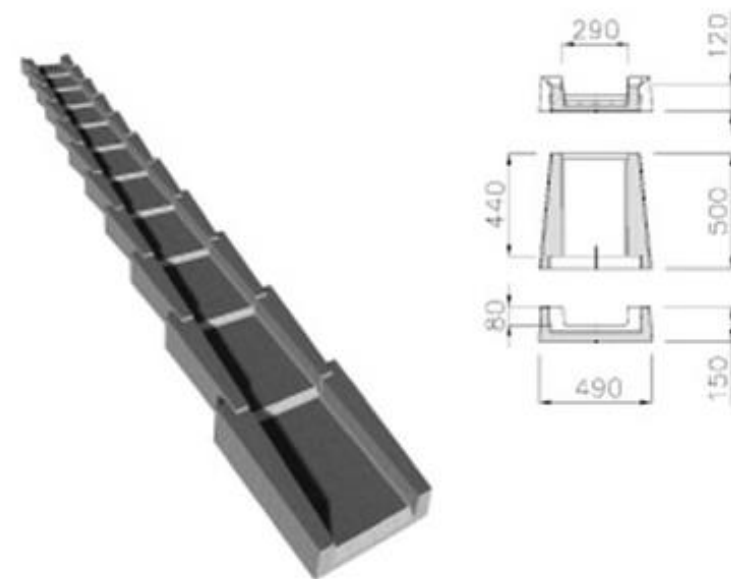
Sección de las bajantes usadas para el dren transversal 1 y 2.
